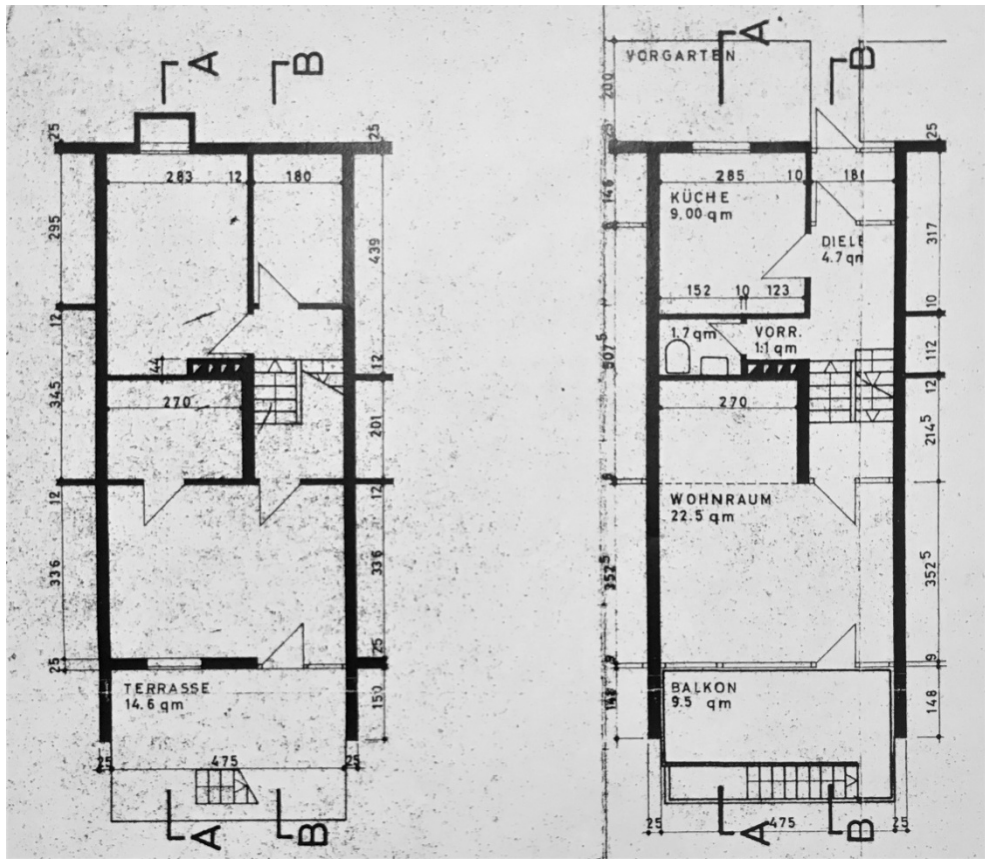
Siedlung Krautberg: Grundrisse Keller und Erdgeschoss (v.l.n.r.), 1967
